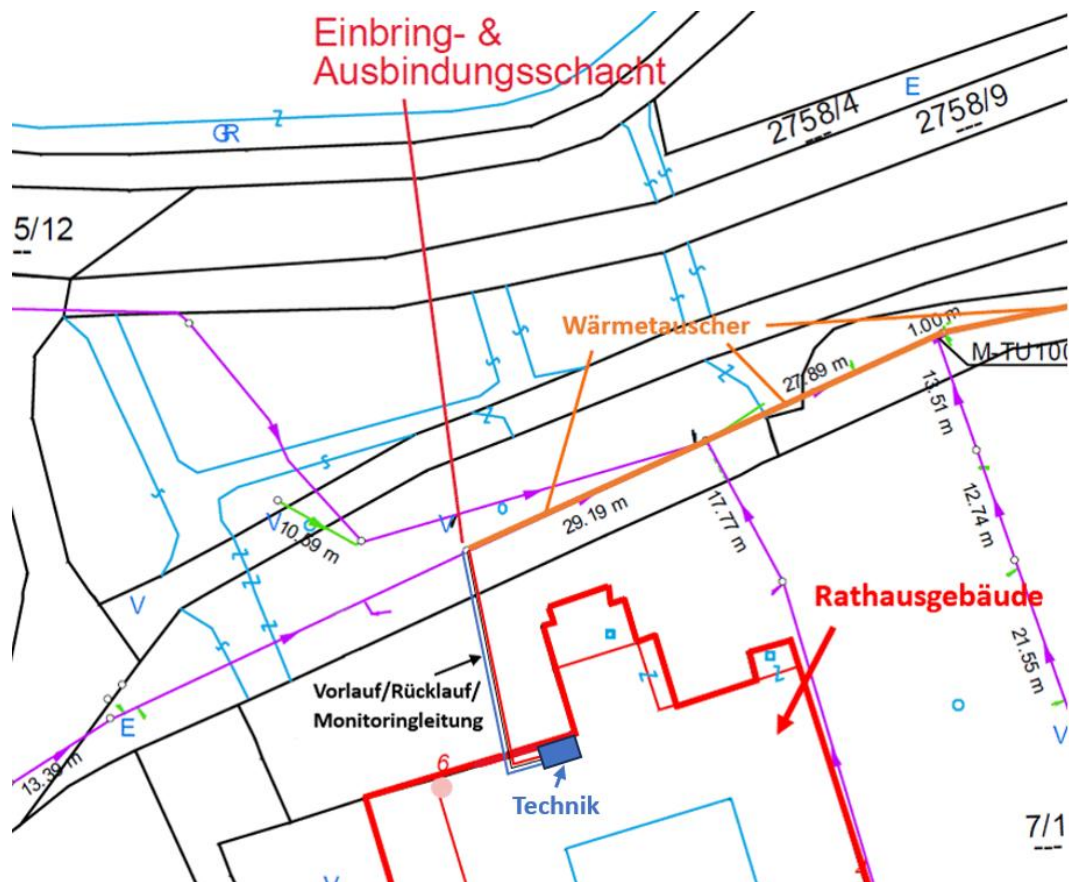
Lageplan mit möglicher Leitungsführung Vor-/Rücklauf zwischen Wärmetauscher-Wärmepumpen im Technikraum (Bildquelle: Stadtgemeinde Tulln, bearb. Rabmer GreenTech GmbH)
